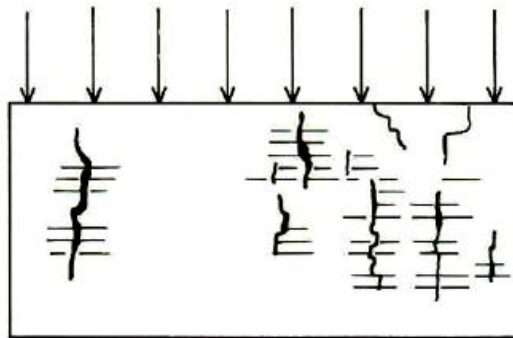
Fissuração causada por sobrecarga vertical.
